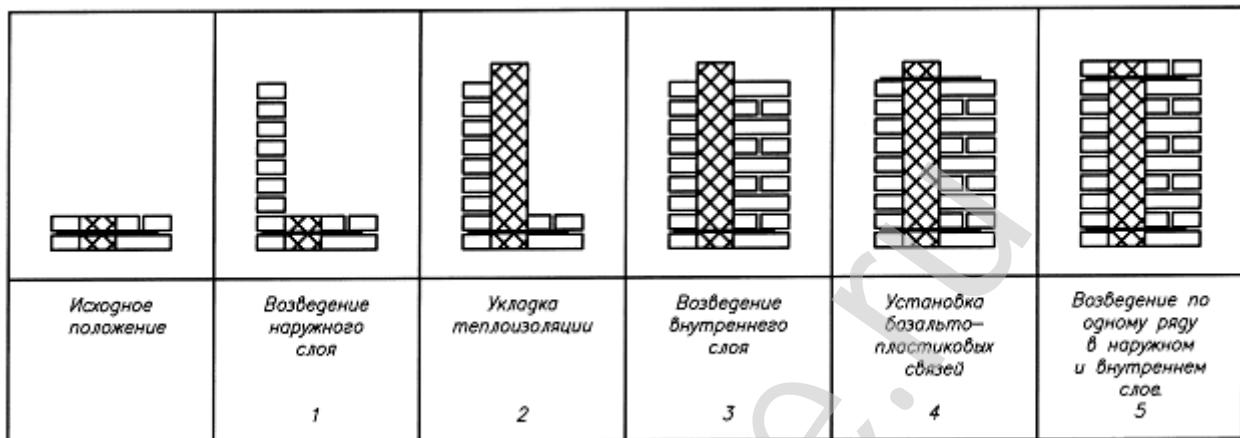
Последовательность кладки стены с теплоизоляцией из пенополистирола или пенополиуретана
